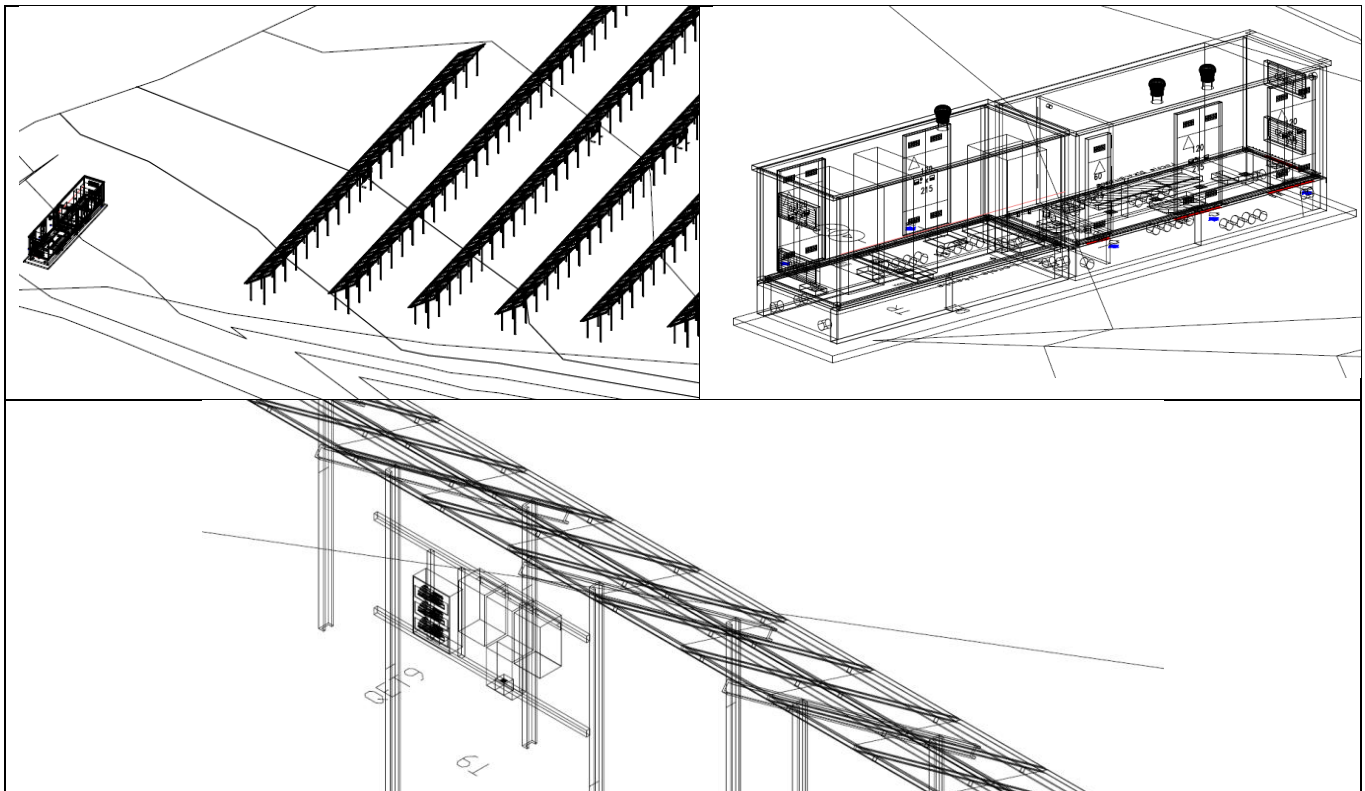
Estratto da Tav.E05.02 – Progetto preliminare, Planimetria 3 Dettagli impianto (cabina e moduli).
